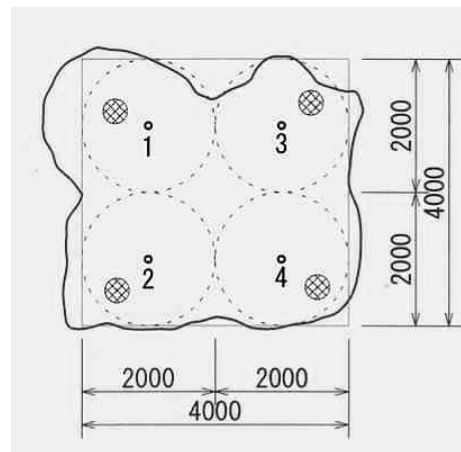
エキスパッカ工法による注入地盤の掘削調査平面図
